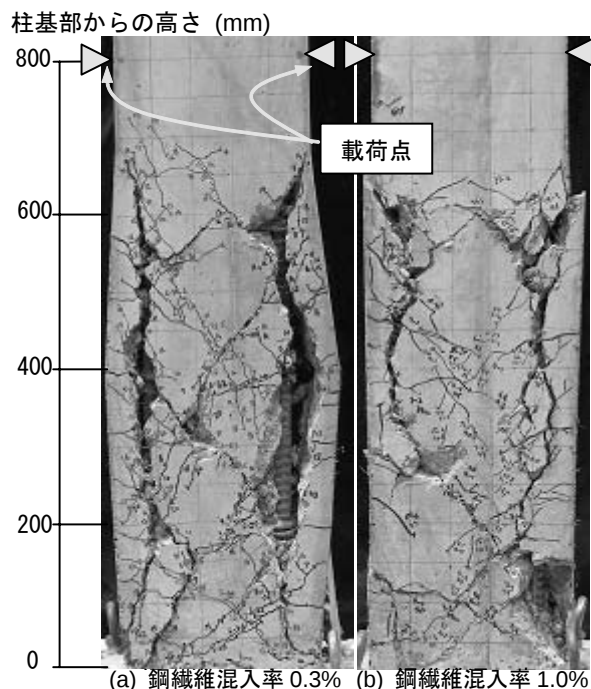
鋼繊維混入率の違いによるひび割れ状況
